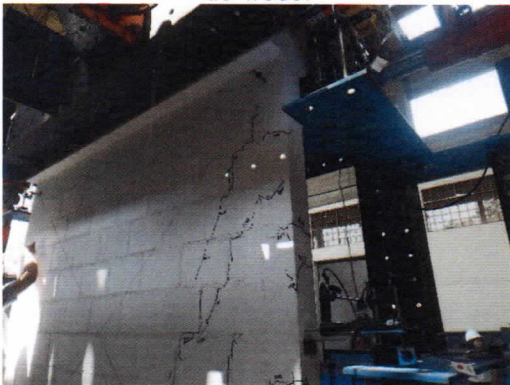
Formación de grietas horizontales en la parte superior de la columna Oeste para una distorsión de 1/800.
